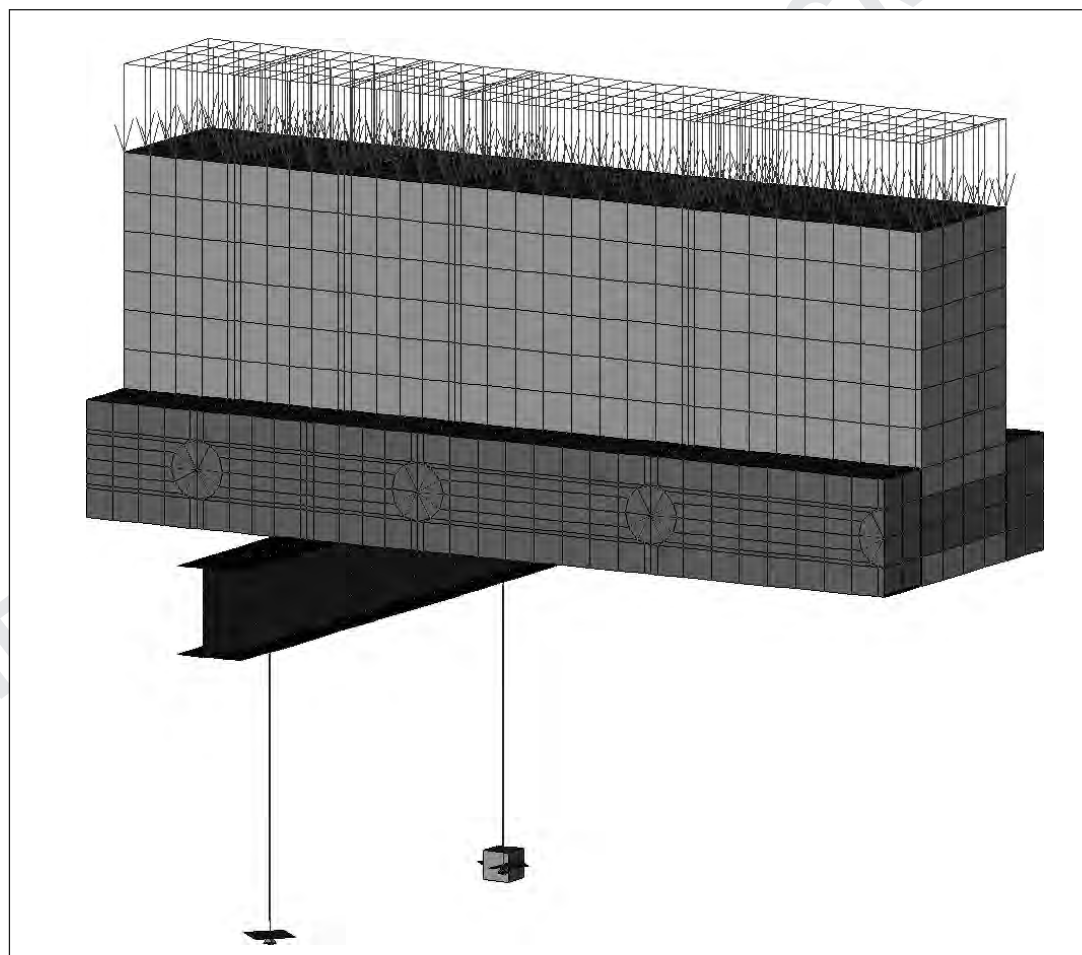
Расчетная схема к определению усилий в кирпичной кладке при опирании на соединительные балки в круглых отверстиях
